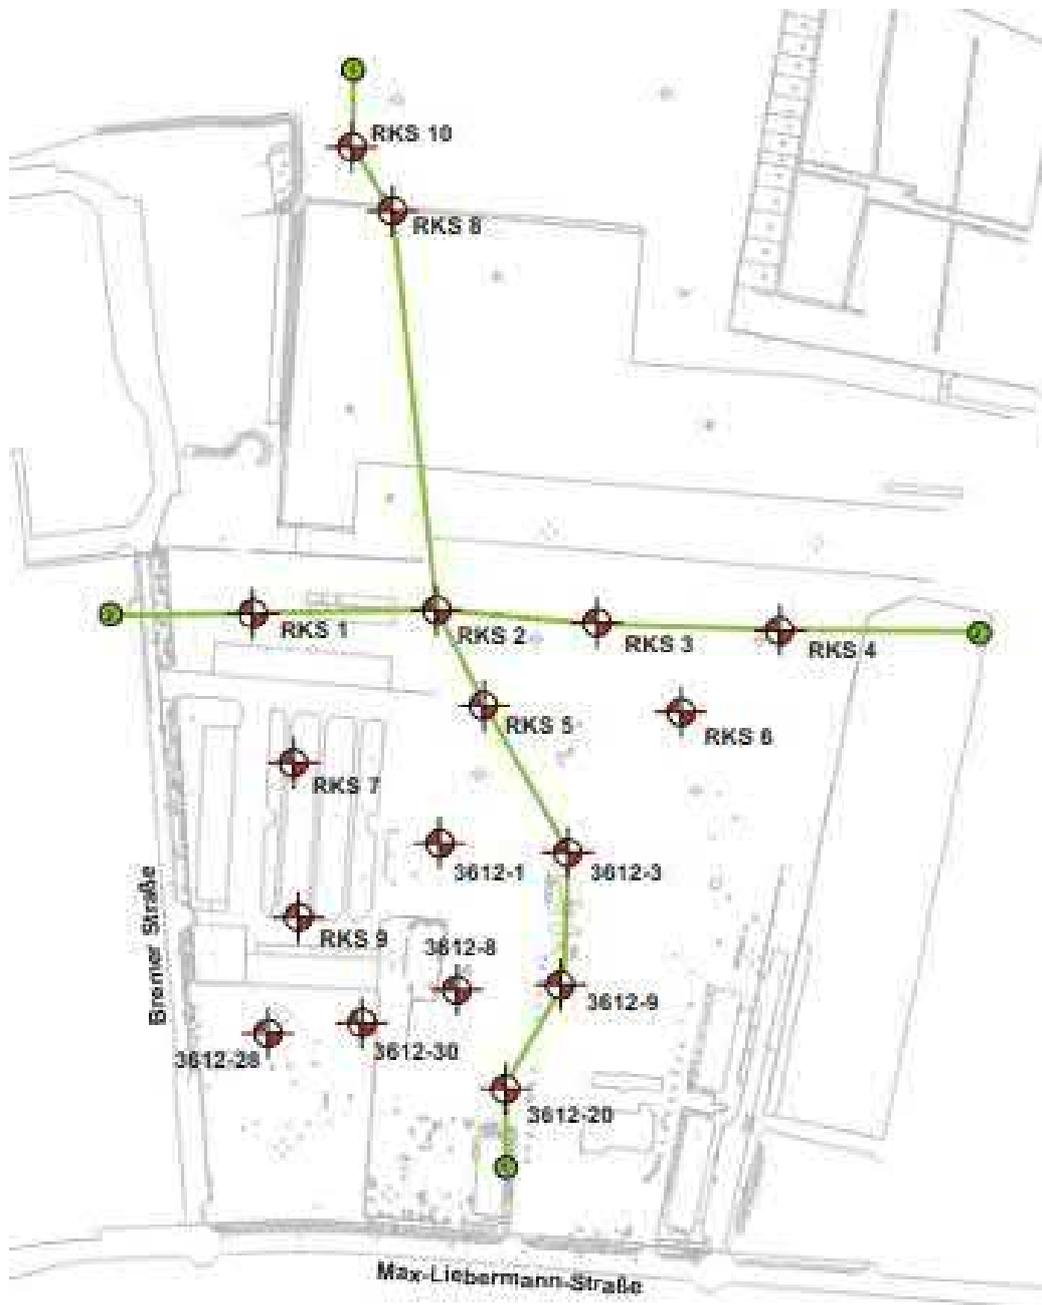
Lageplan der durchgeführten Rammkernsondierungen, IUH
